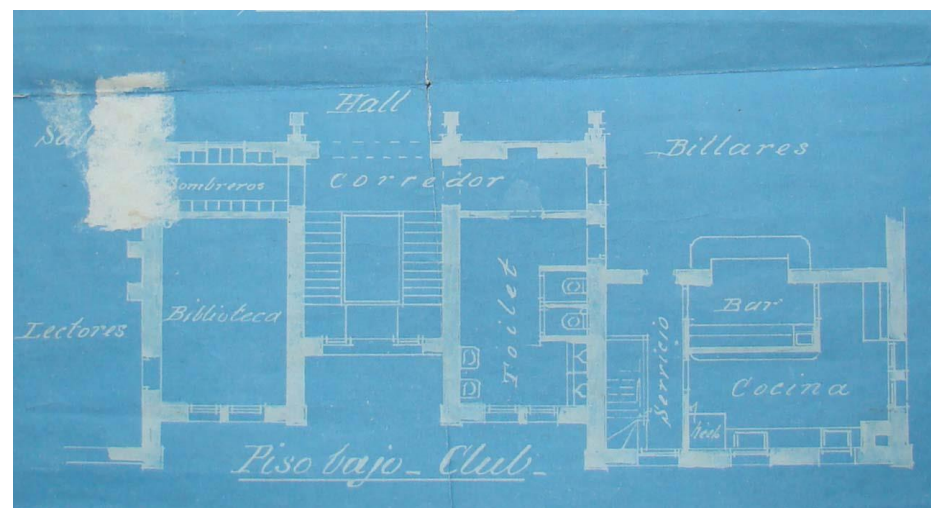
Planta Baixa Clube, 09-12-1918, Prancha n.98. Acervo: Clube Campestre.
